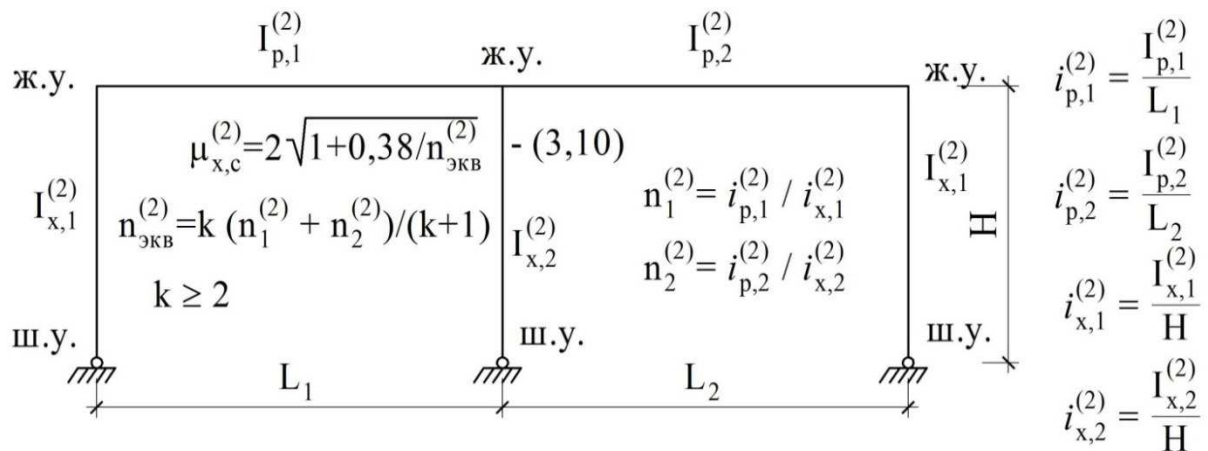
Расчетная схема двухпролетной свободной поперечной рамы: верхние узлы - жесткие; нижние - шарнирные; поперечные сечения колонн - постоянные; ригель - эквивалентные стержни
